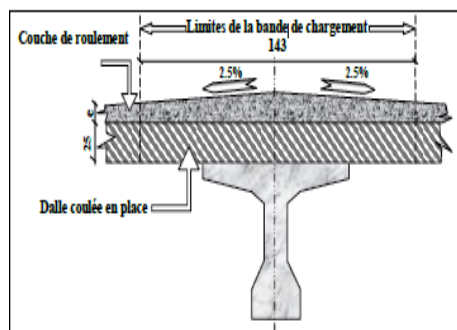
b. Détails de la dalle et de la couche de roulement [22].
